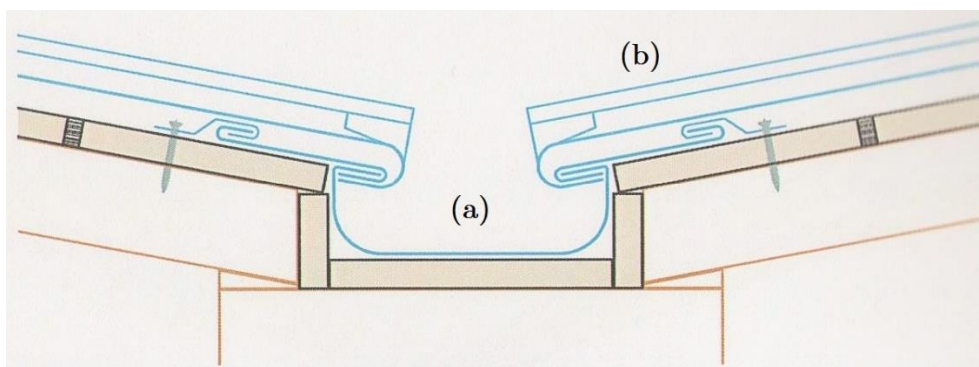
Talvegue com degrau, (a) – Talvegue com degrau, (b) – Placas de revestimento da cobertura
